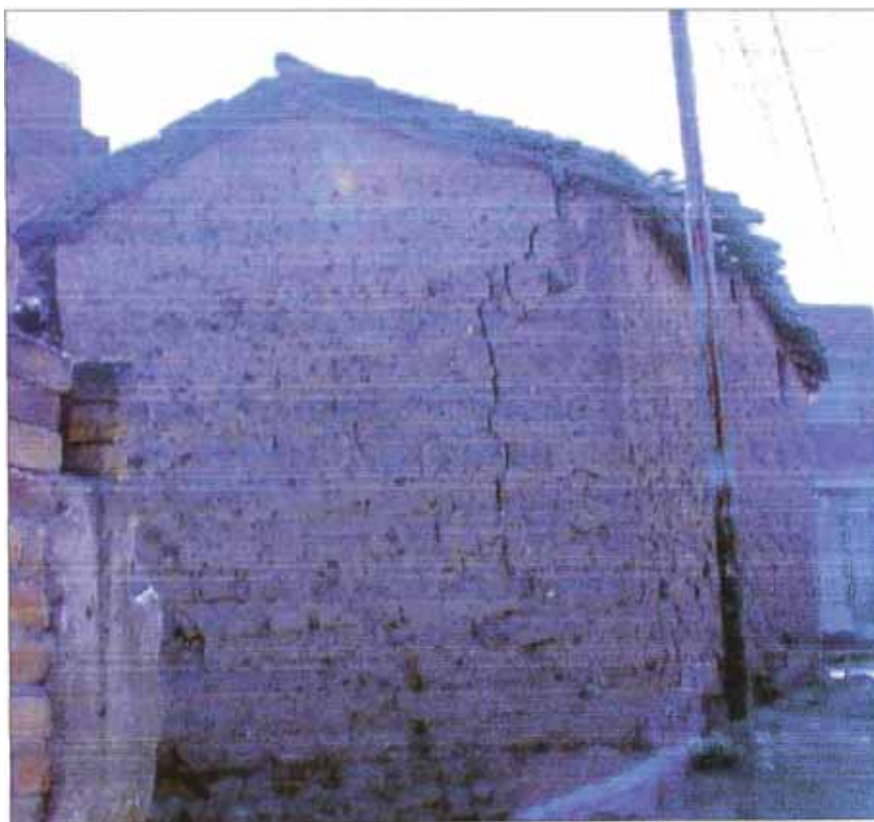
Mampostería de adobe sin arriostamiento horizontal y vertical.
